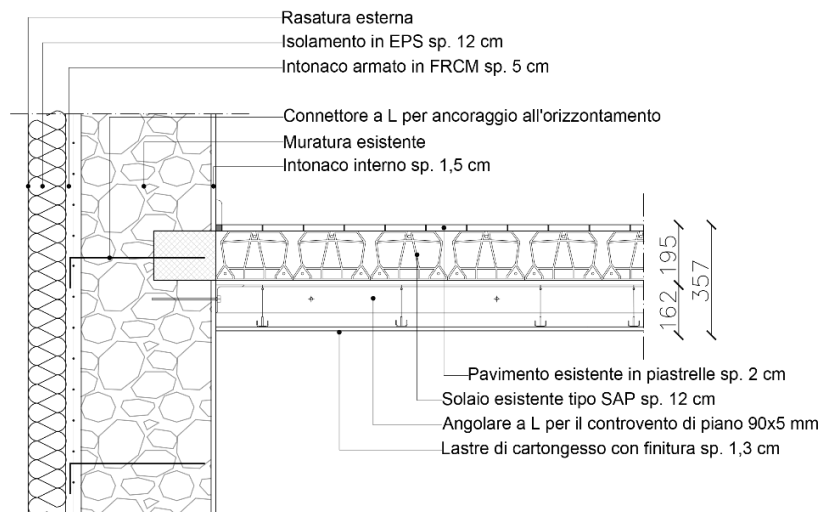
Dettaglio in sezione degli interventi di consolidamento mediante controventi in acciaio e collegamenti.
